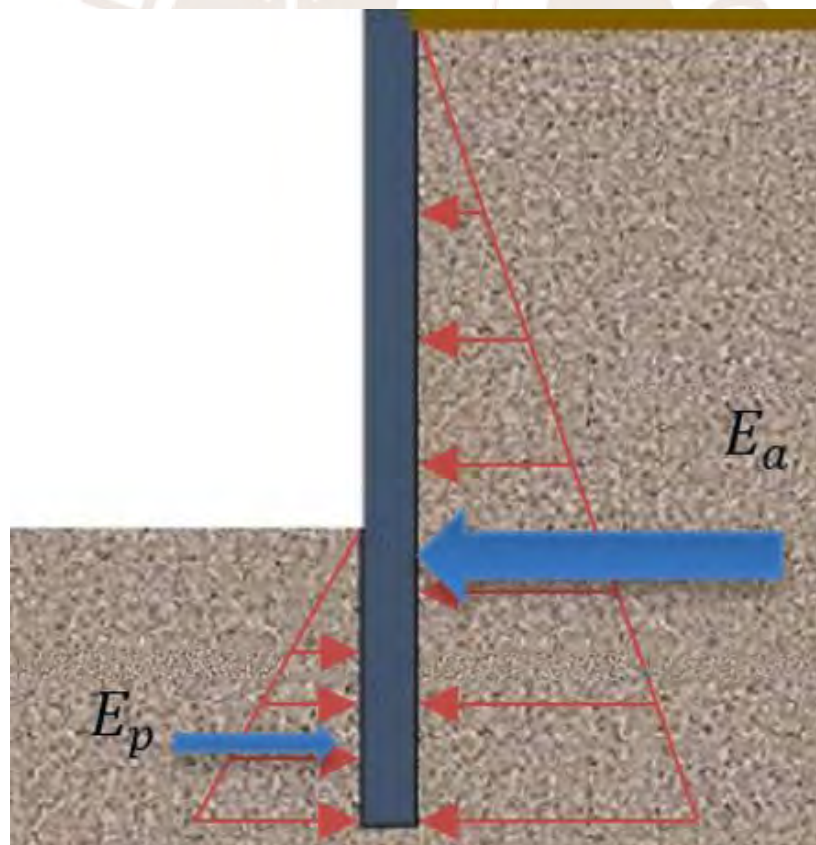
Empujes activo y pasivo en un muro pantalla empotrada. Fuente: Propia.
